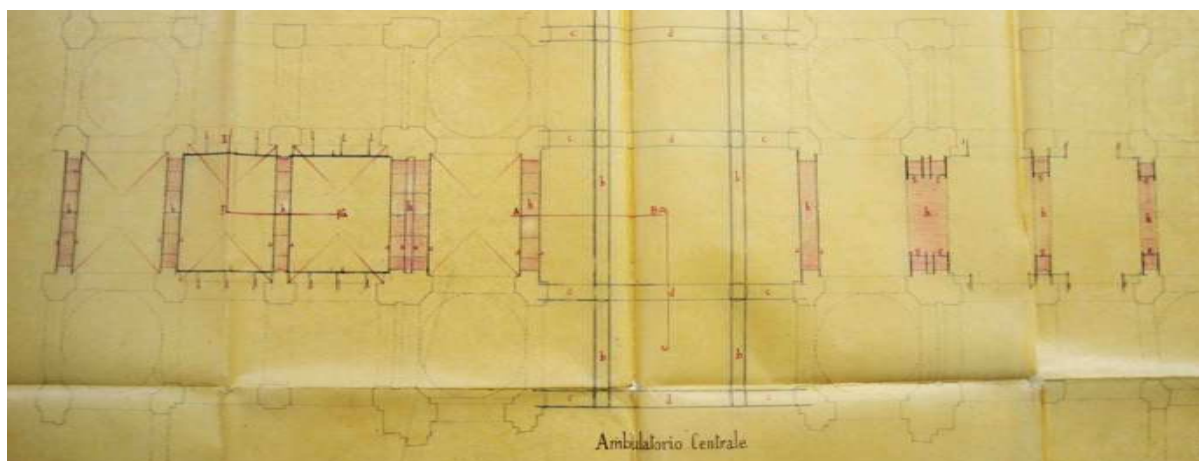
Palazzo di Giustizia di Roma, Disposizione planimetrica dell'orditura delle travi nei soffitti dell'Ambulatio centrale (cfr. Fig. 1) (ACS, Roma, Min. LL.PP., OGE, Palazzo di Giustizia, b. 211, fasc. 519)
